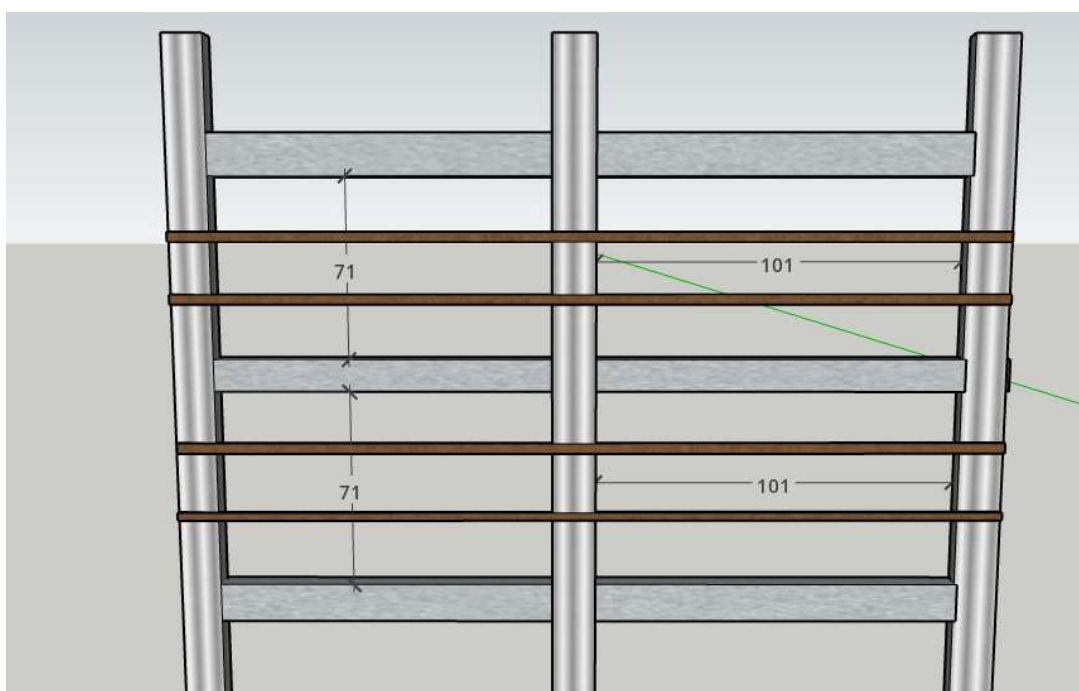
Vista traseira da estrutura, detalhando as dimensões
